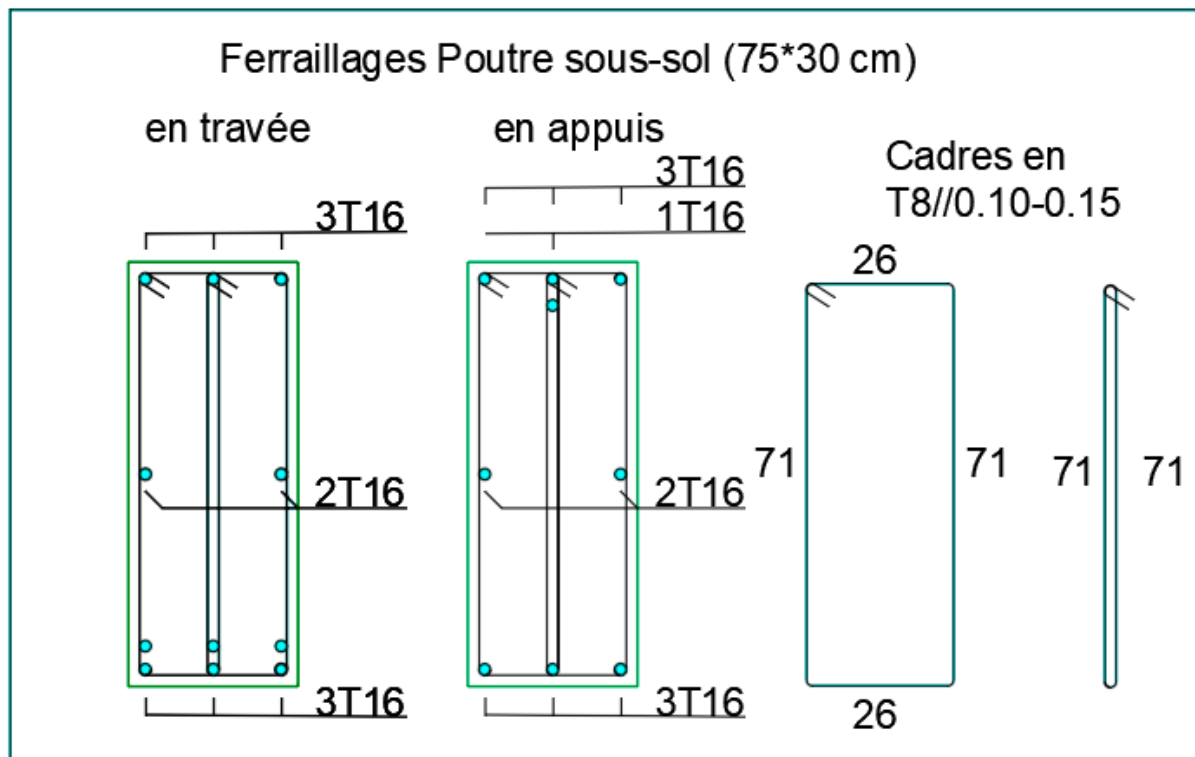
Ferraillages Poutre Sous-sol 73*30 cm.
